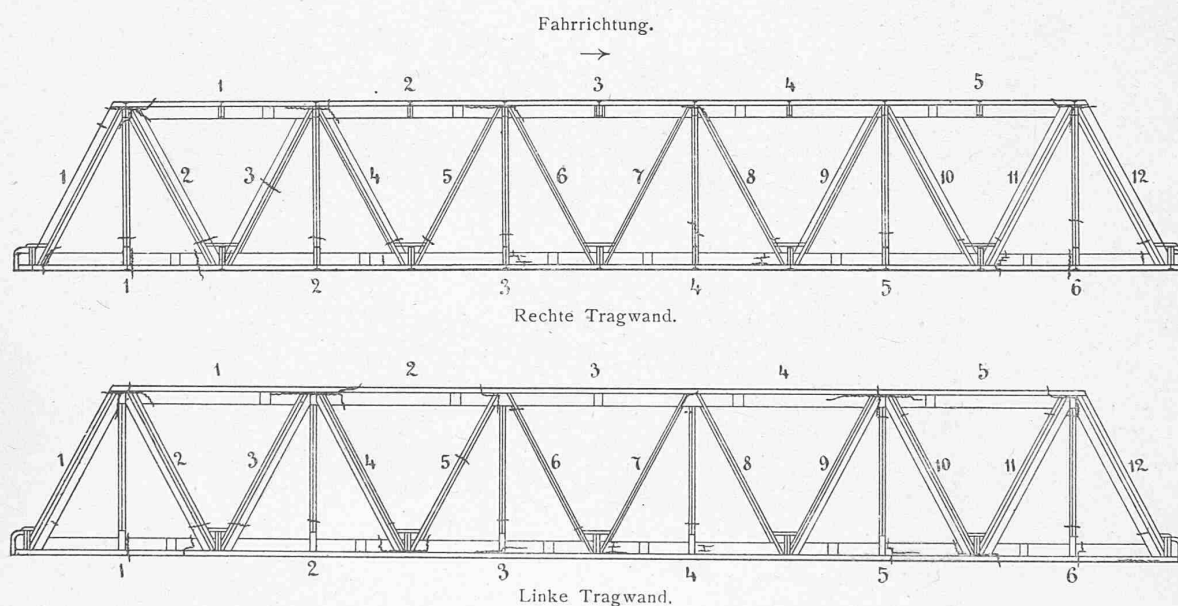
und 63. Uebersicht der eingetretenen Risse.
